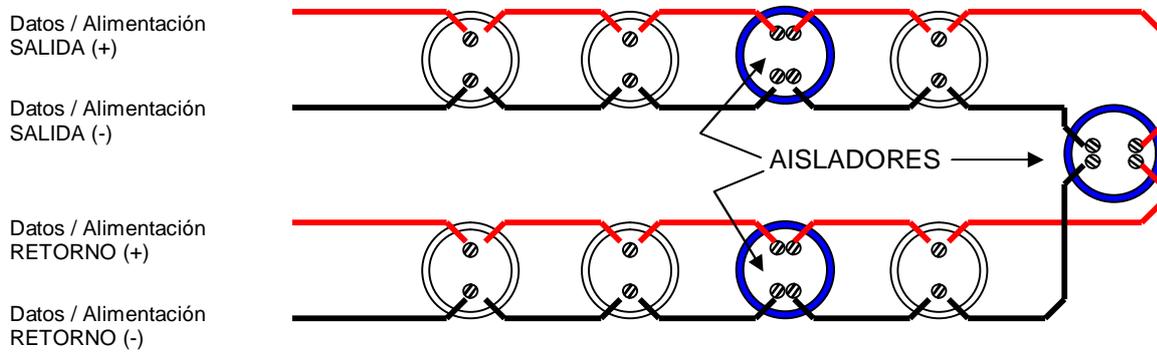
Conexión del lazo con aisladores – Opción recomendada
